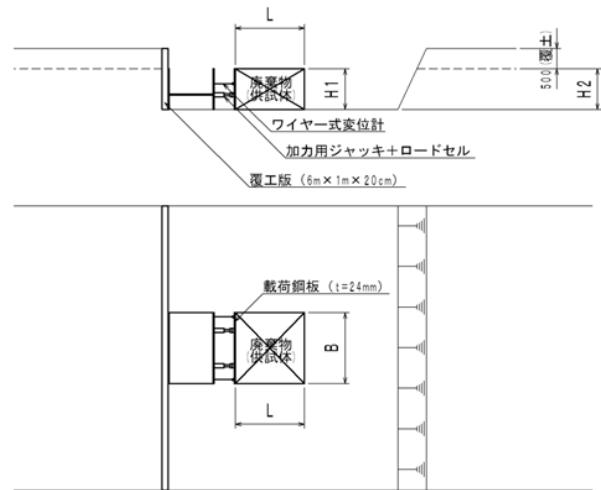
廃棄物崩壊試験方法(上:断面図;下:平面図)
